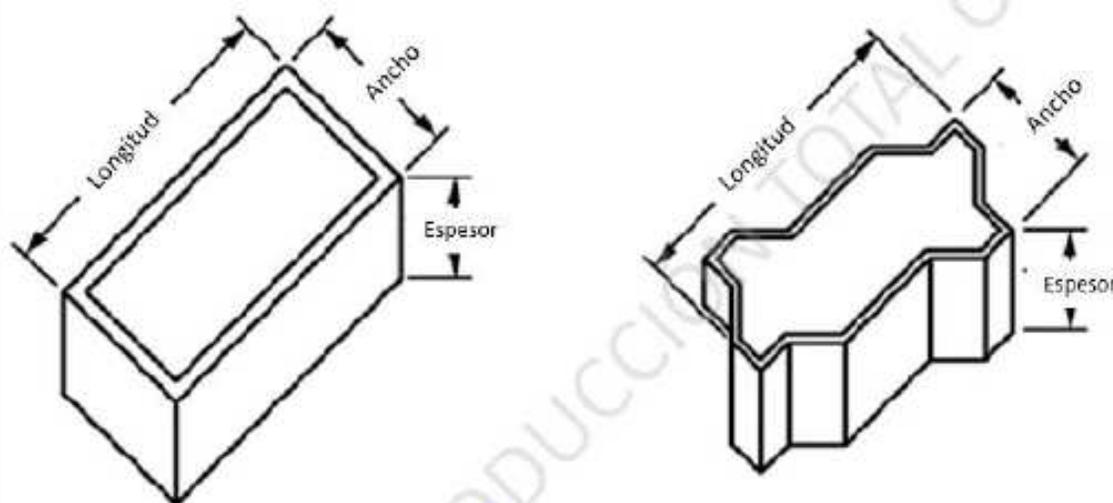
Longitud, ancho y espesor de las unidades de concreto para pavimentos
